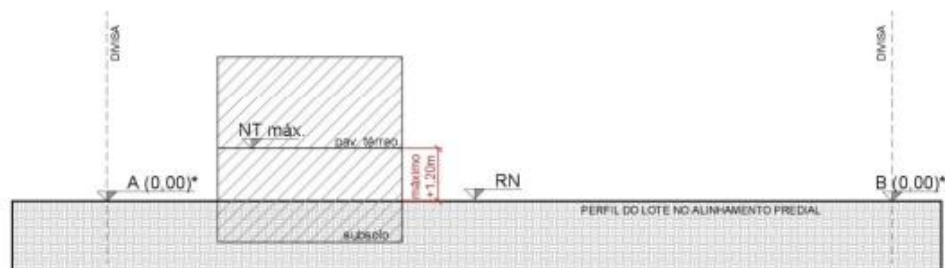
B: Corte ilustrativo transversal da definição da RN e NT em terreno plano na testada (sem escala)
